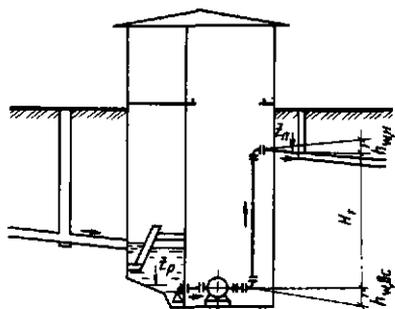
Схема подачи сточной жидкости из заглубленного коллектора в верхний
